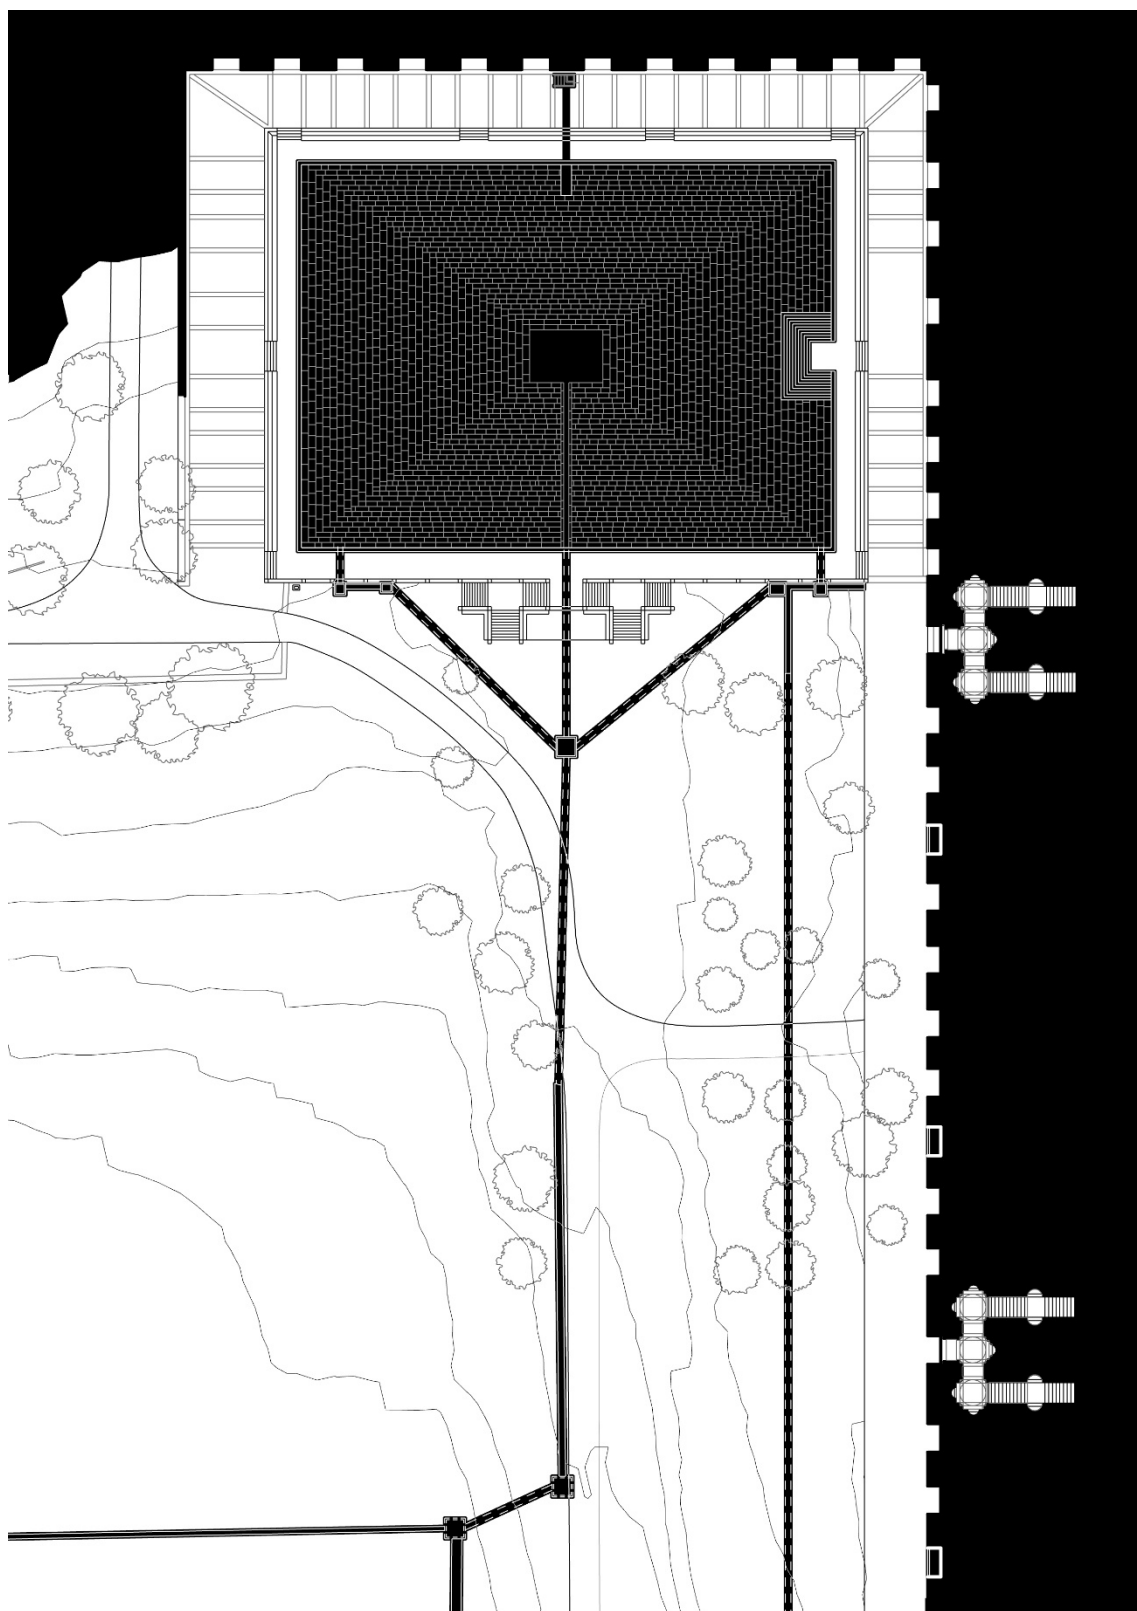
Planta del estanque y conducciones del sistema de riego en la huerta.
